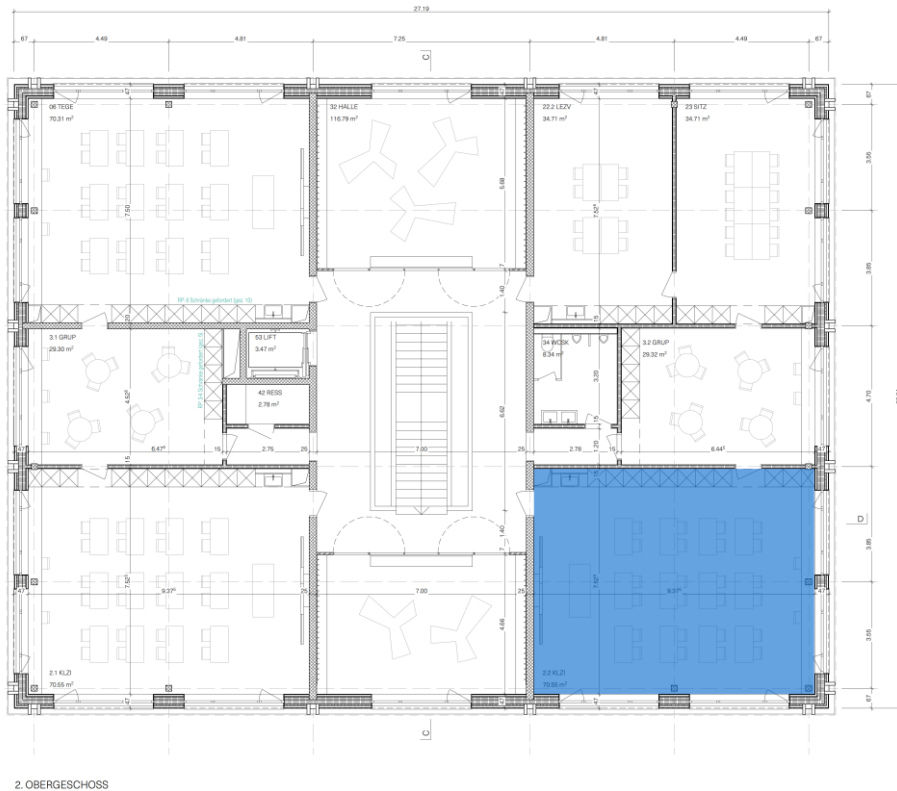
Kritisches Schulzimmer im Grundriss
